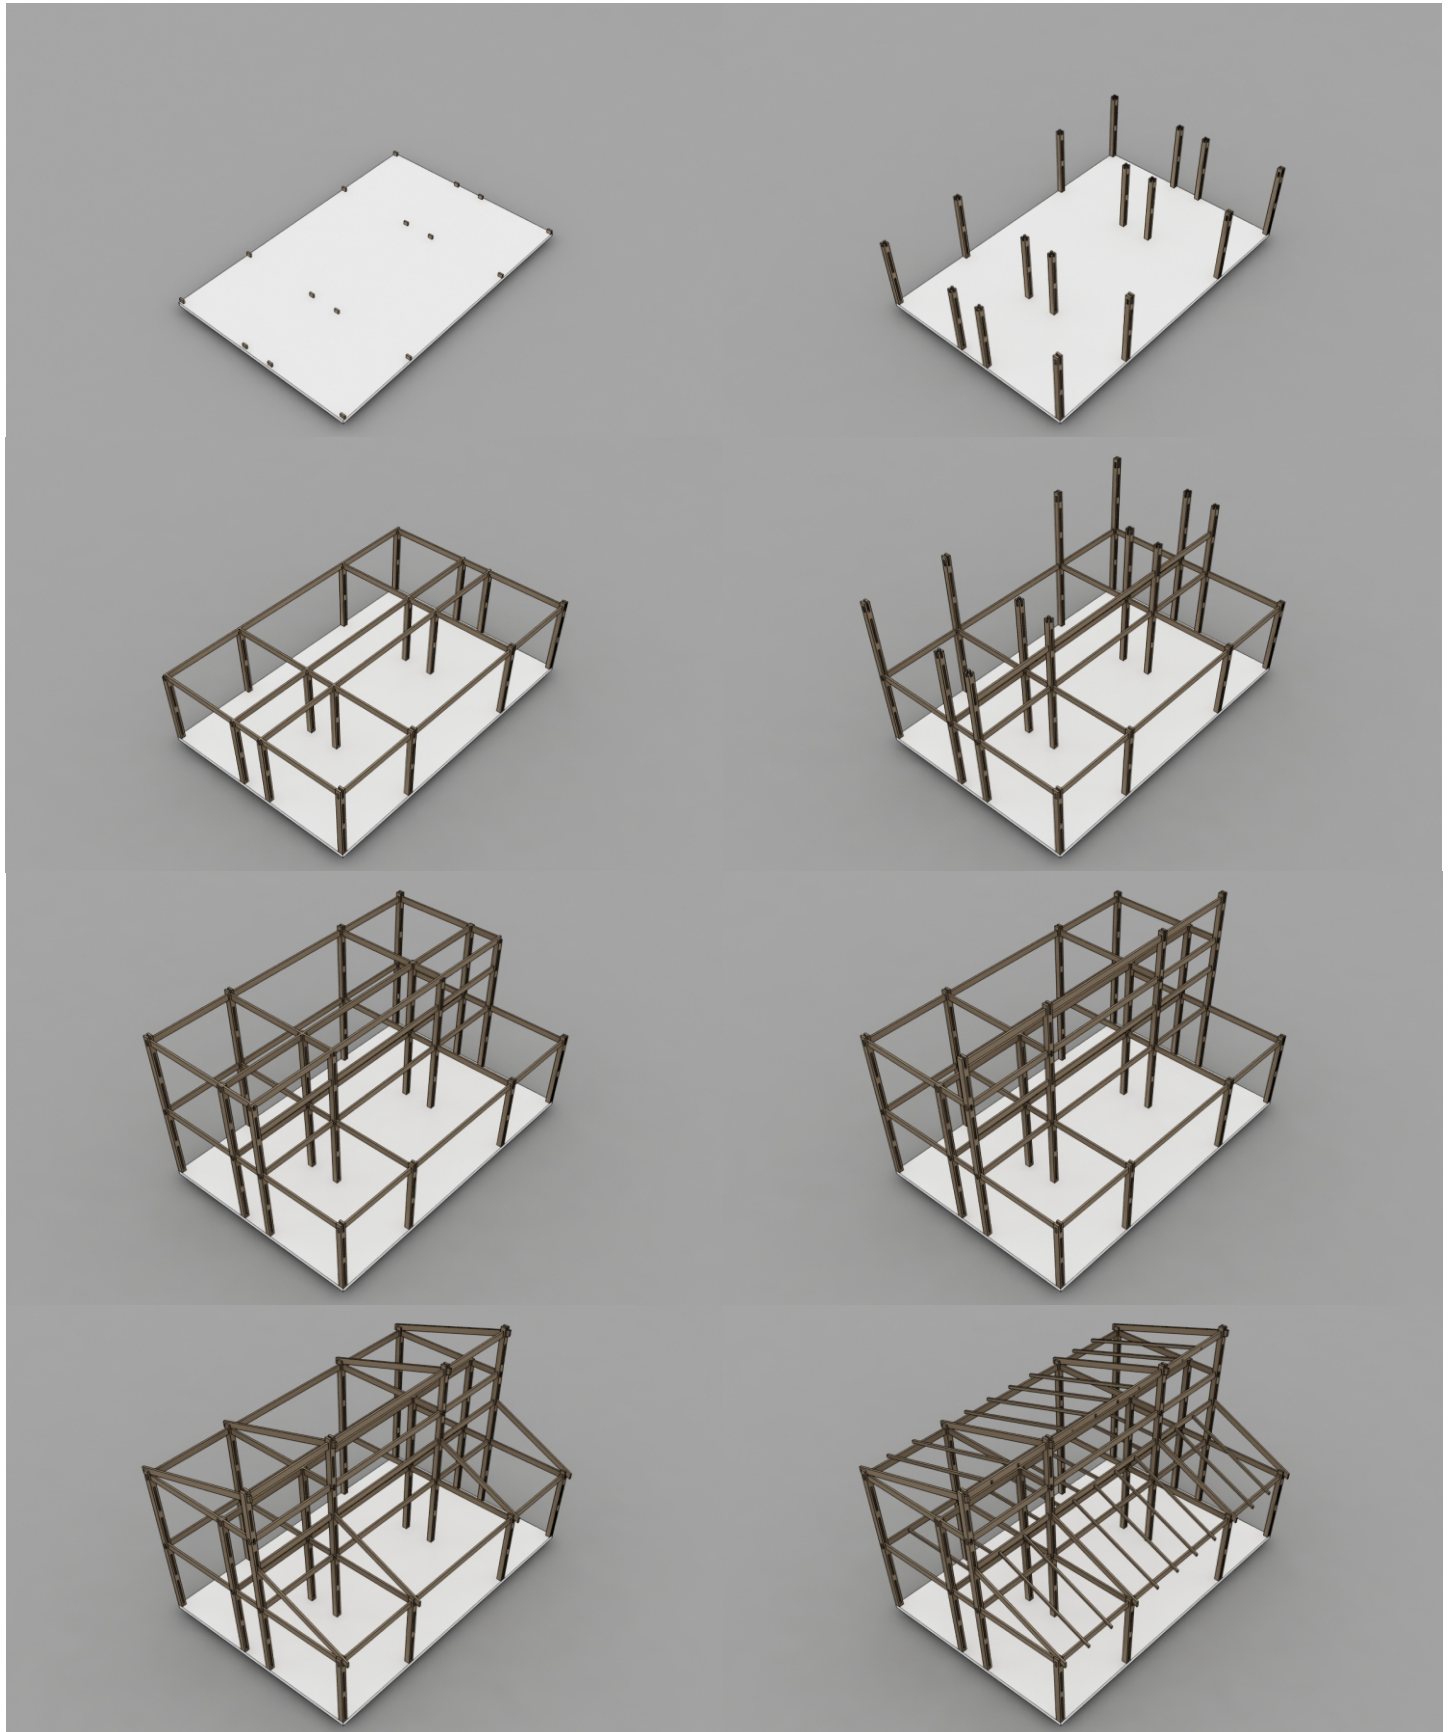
Imagen de secuencia de colocacion de elementos estructurales y tiranteria
